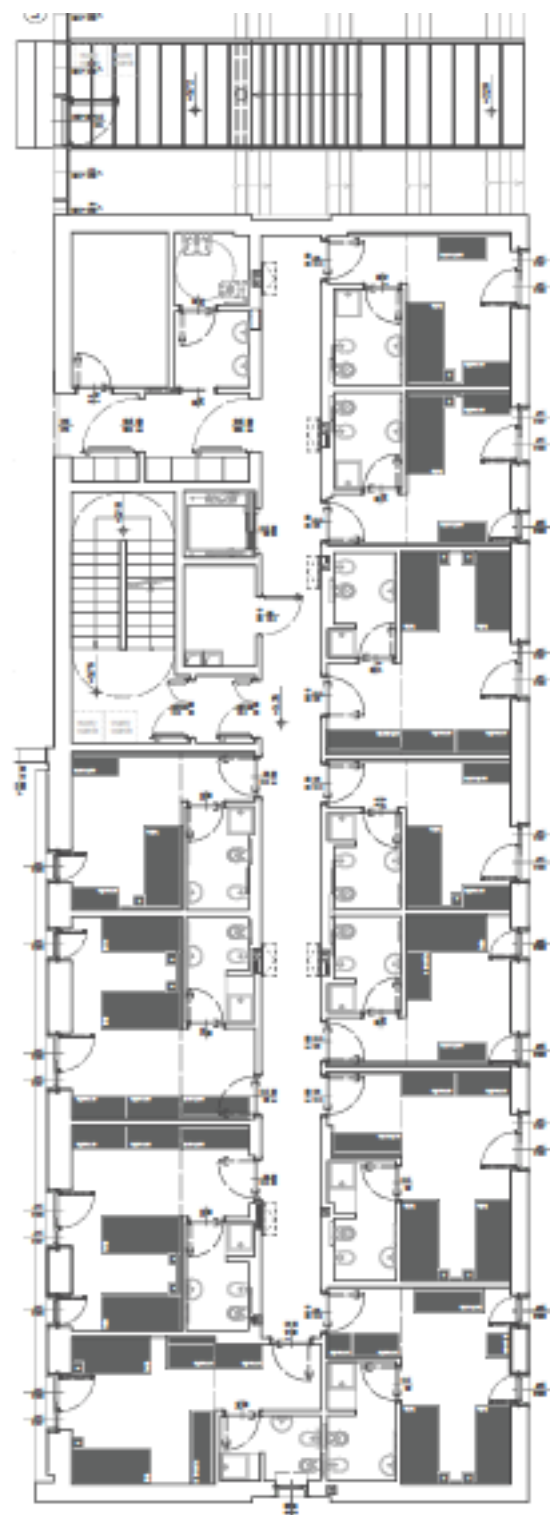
sopra: Piano tipo corpo A, appartamenti – Fonte: archivio In-Domus
